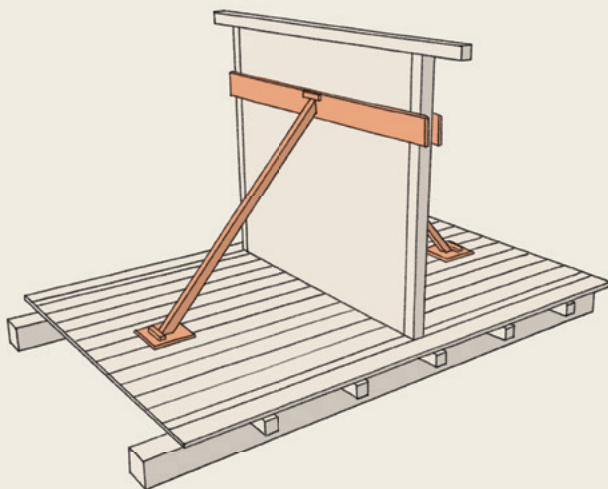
Escoramento da parede para realização de intervenção parcial em estrutura secundária.
